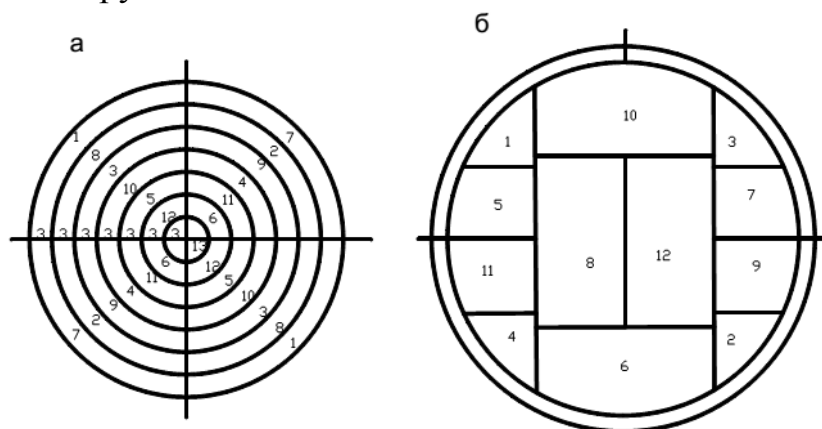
Послідовність укладки бетону у днище колодязя: а – першого шару бетону в днище діаметром 40 м і більше; б – другого шару бетону
